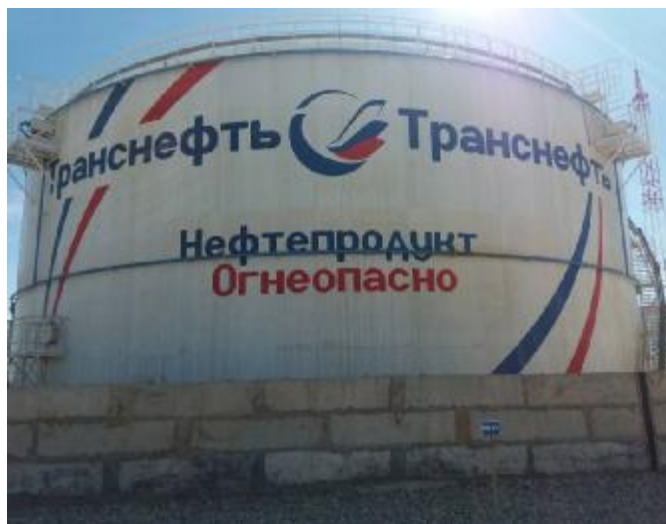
Общий вид резервуаров РВСП-10000 зав.№№ 15, 19, 22
